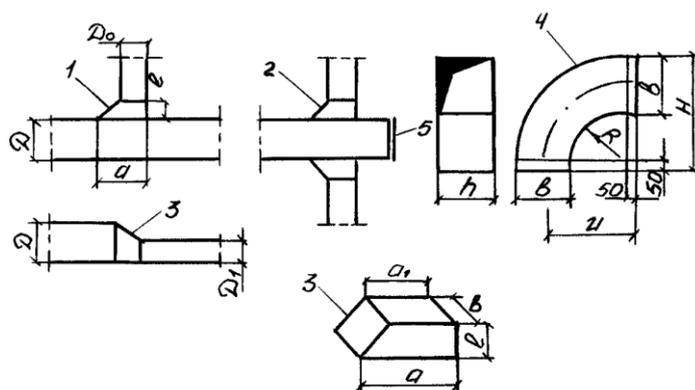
Унифицированные фасонные части воздуховодов: а – круглого сечения; б – прямоугольного сечения; 1 – прямой тройник; 2 – штанообразный тройник (без заглушки крестовина); 3 – переход; 4 – отводы под углом 90° и 45°; 5 – заглушка; 6 – базовая врезка.
